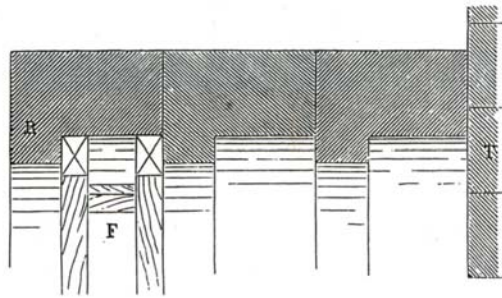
Cimbras utilizadas en la edificación de las galerías de las termas de Hierápolis. CHOISY (1883), 1997, fig.12, p.20
